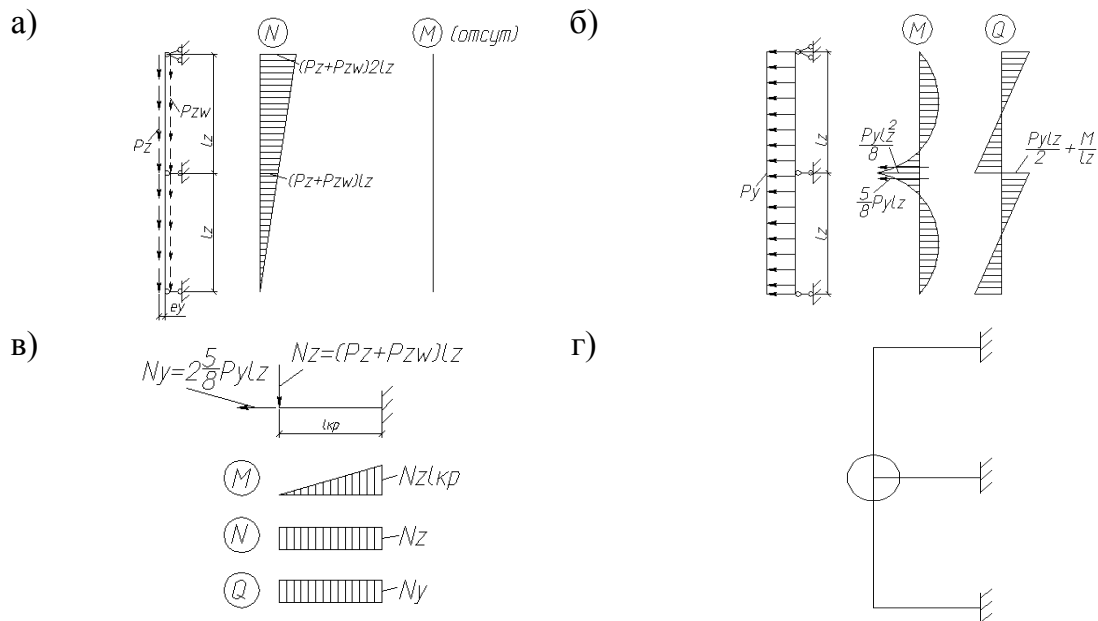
Расчетные схемы: а – б - для расчета вертикального профиля: на вертикальную нагрузку (а); на горизонтальную нагрузку (б); в - для расчета кронштейна; г - для расчета узла крепления кронштейна к вертикальному профилю
